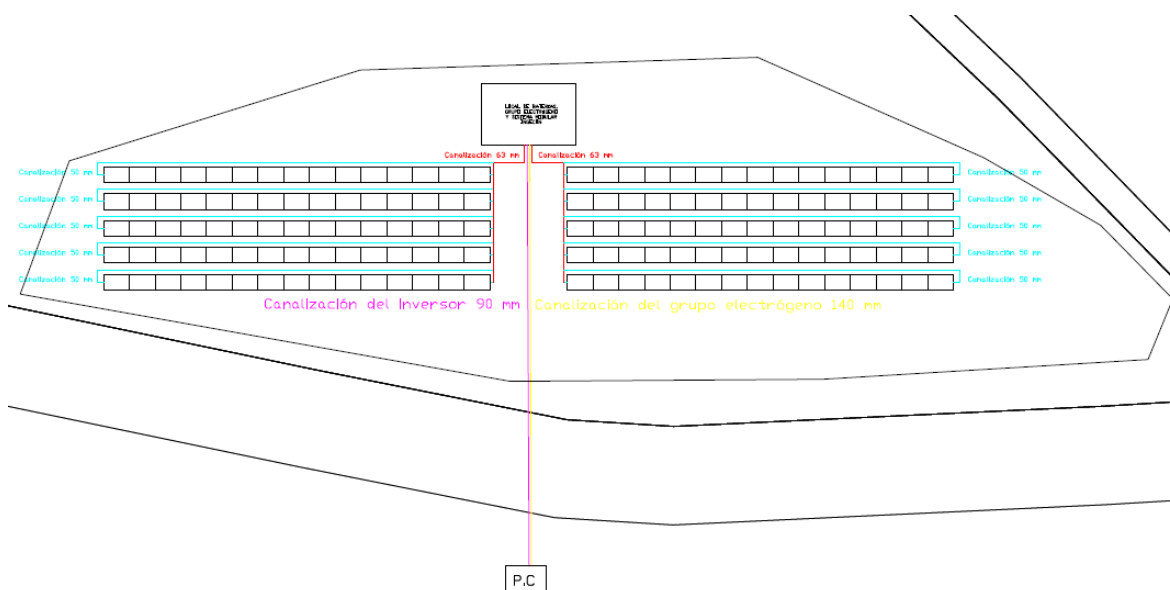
Plano de las canalizaciones enterradas de la instalación fotovoltaica
